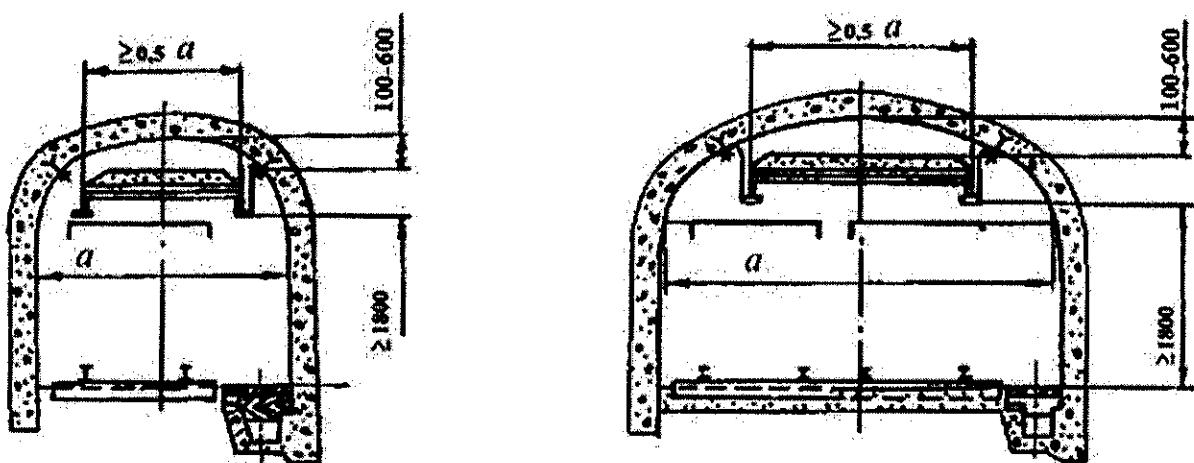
Схема установки сланцевых заслонов в выработках, закрепленных бетонной крепью
